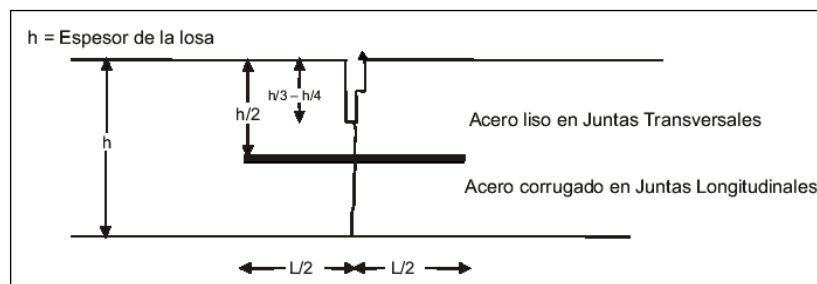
Junta de Contracción para Losas del Pavimento Rígido
